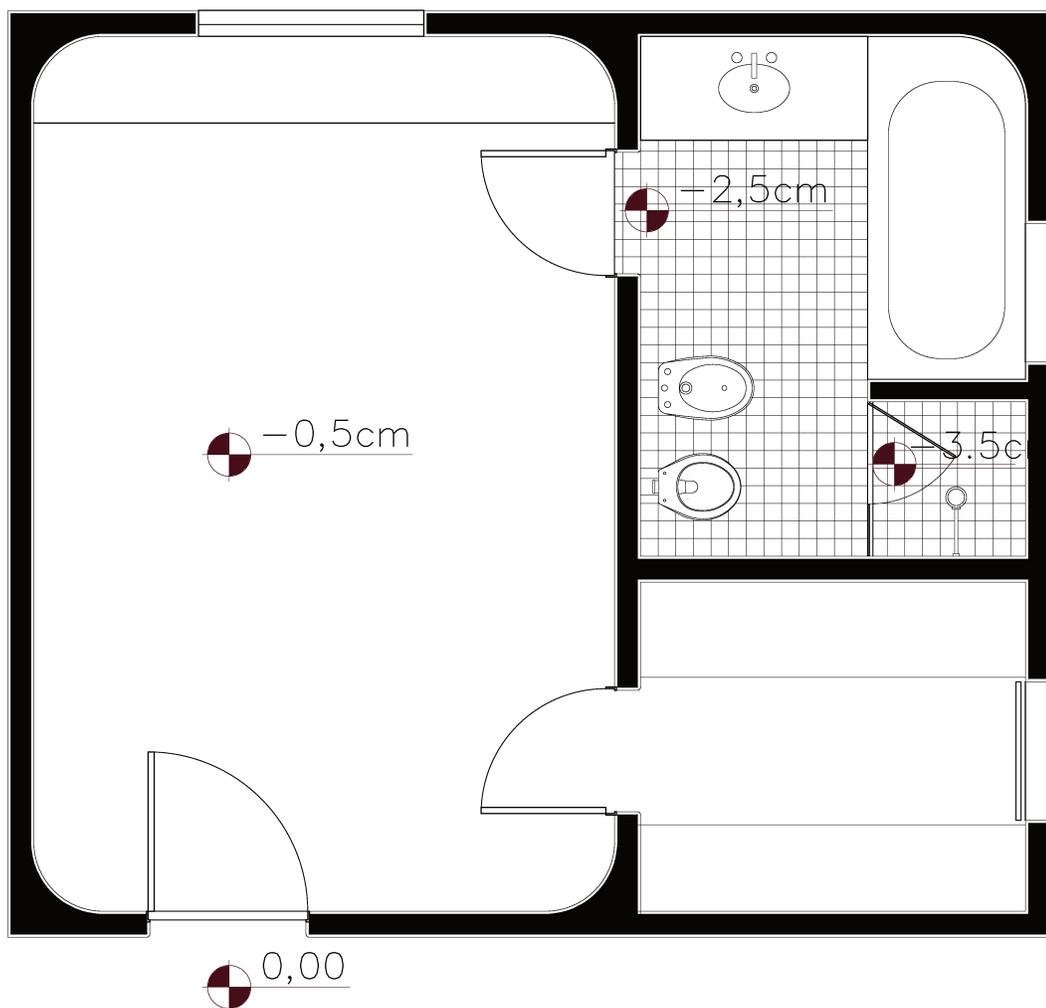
planta de levantamento da suíte do estudo de caso 2.
